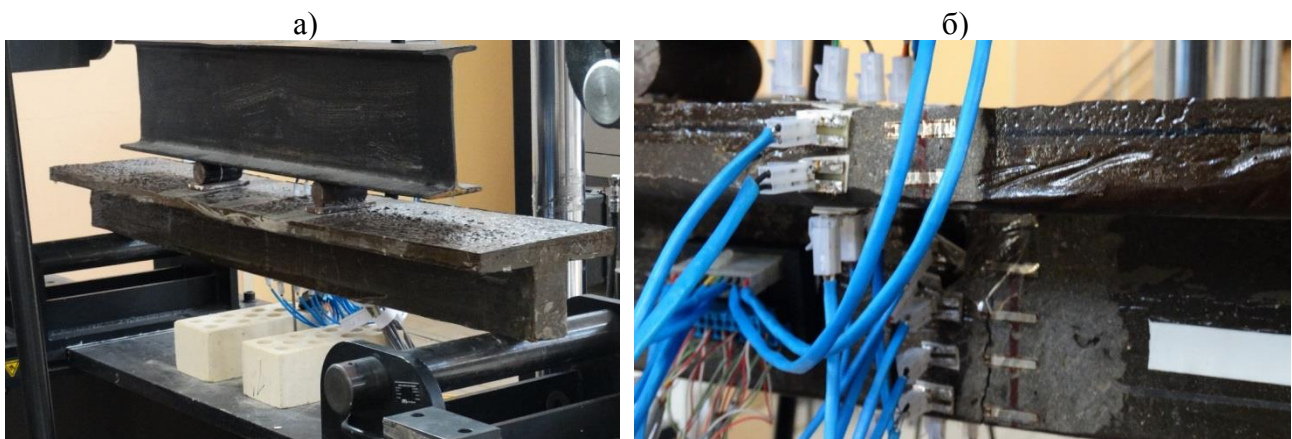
Общий вид балки до (а) и после испытания (б)
